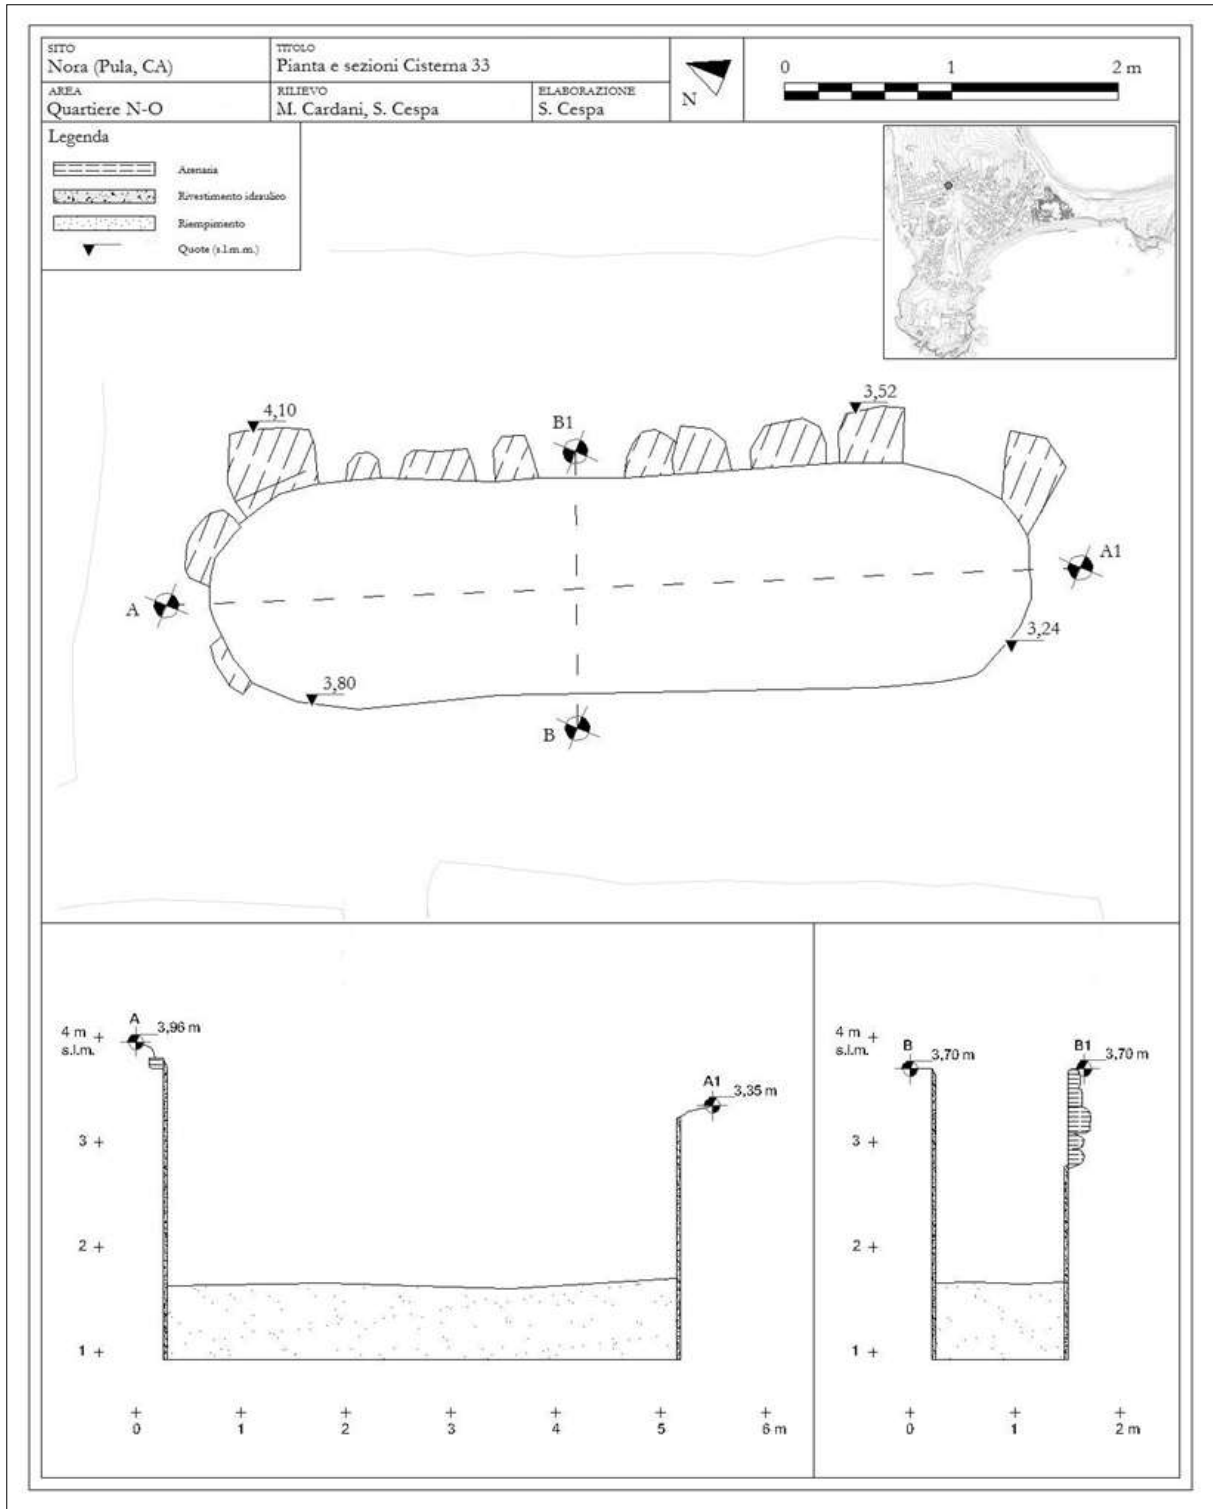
Pianta e sezioni della cisterna 33 (elaborazione dell'autore).
